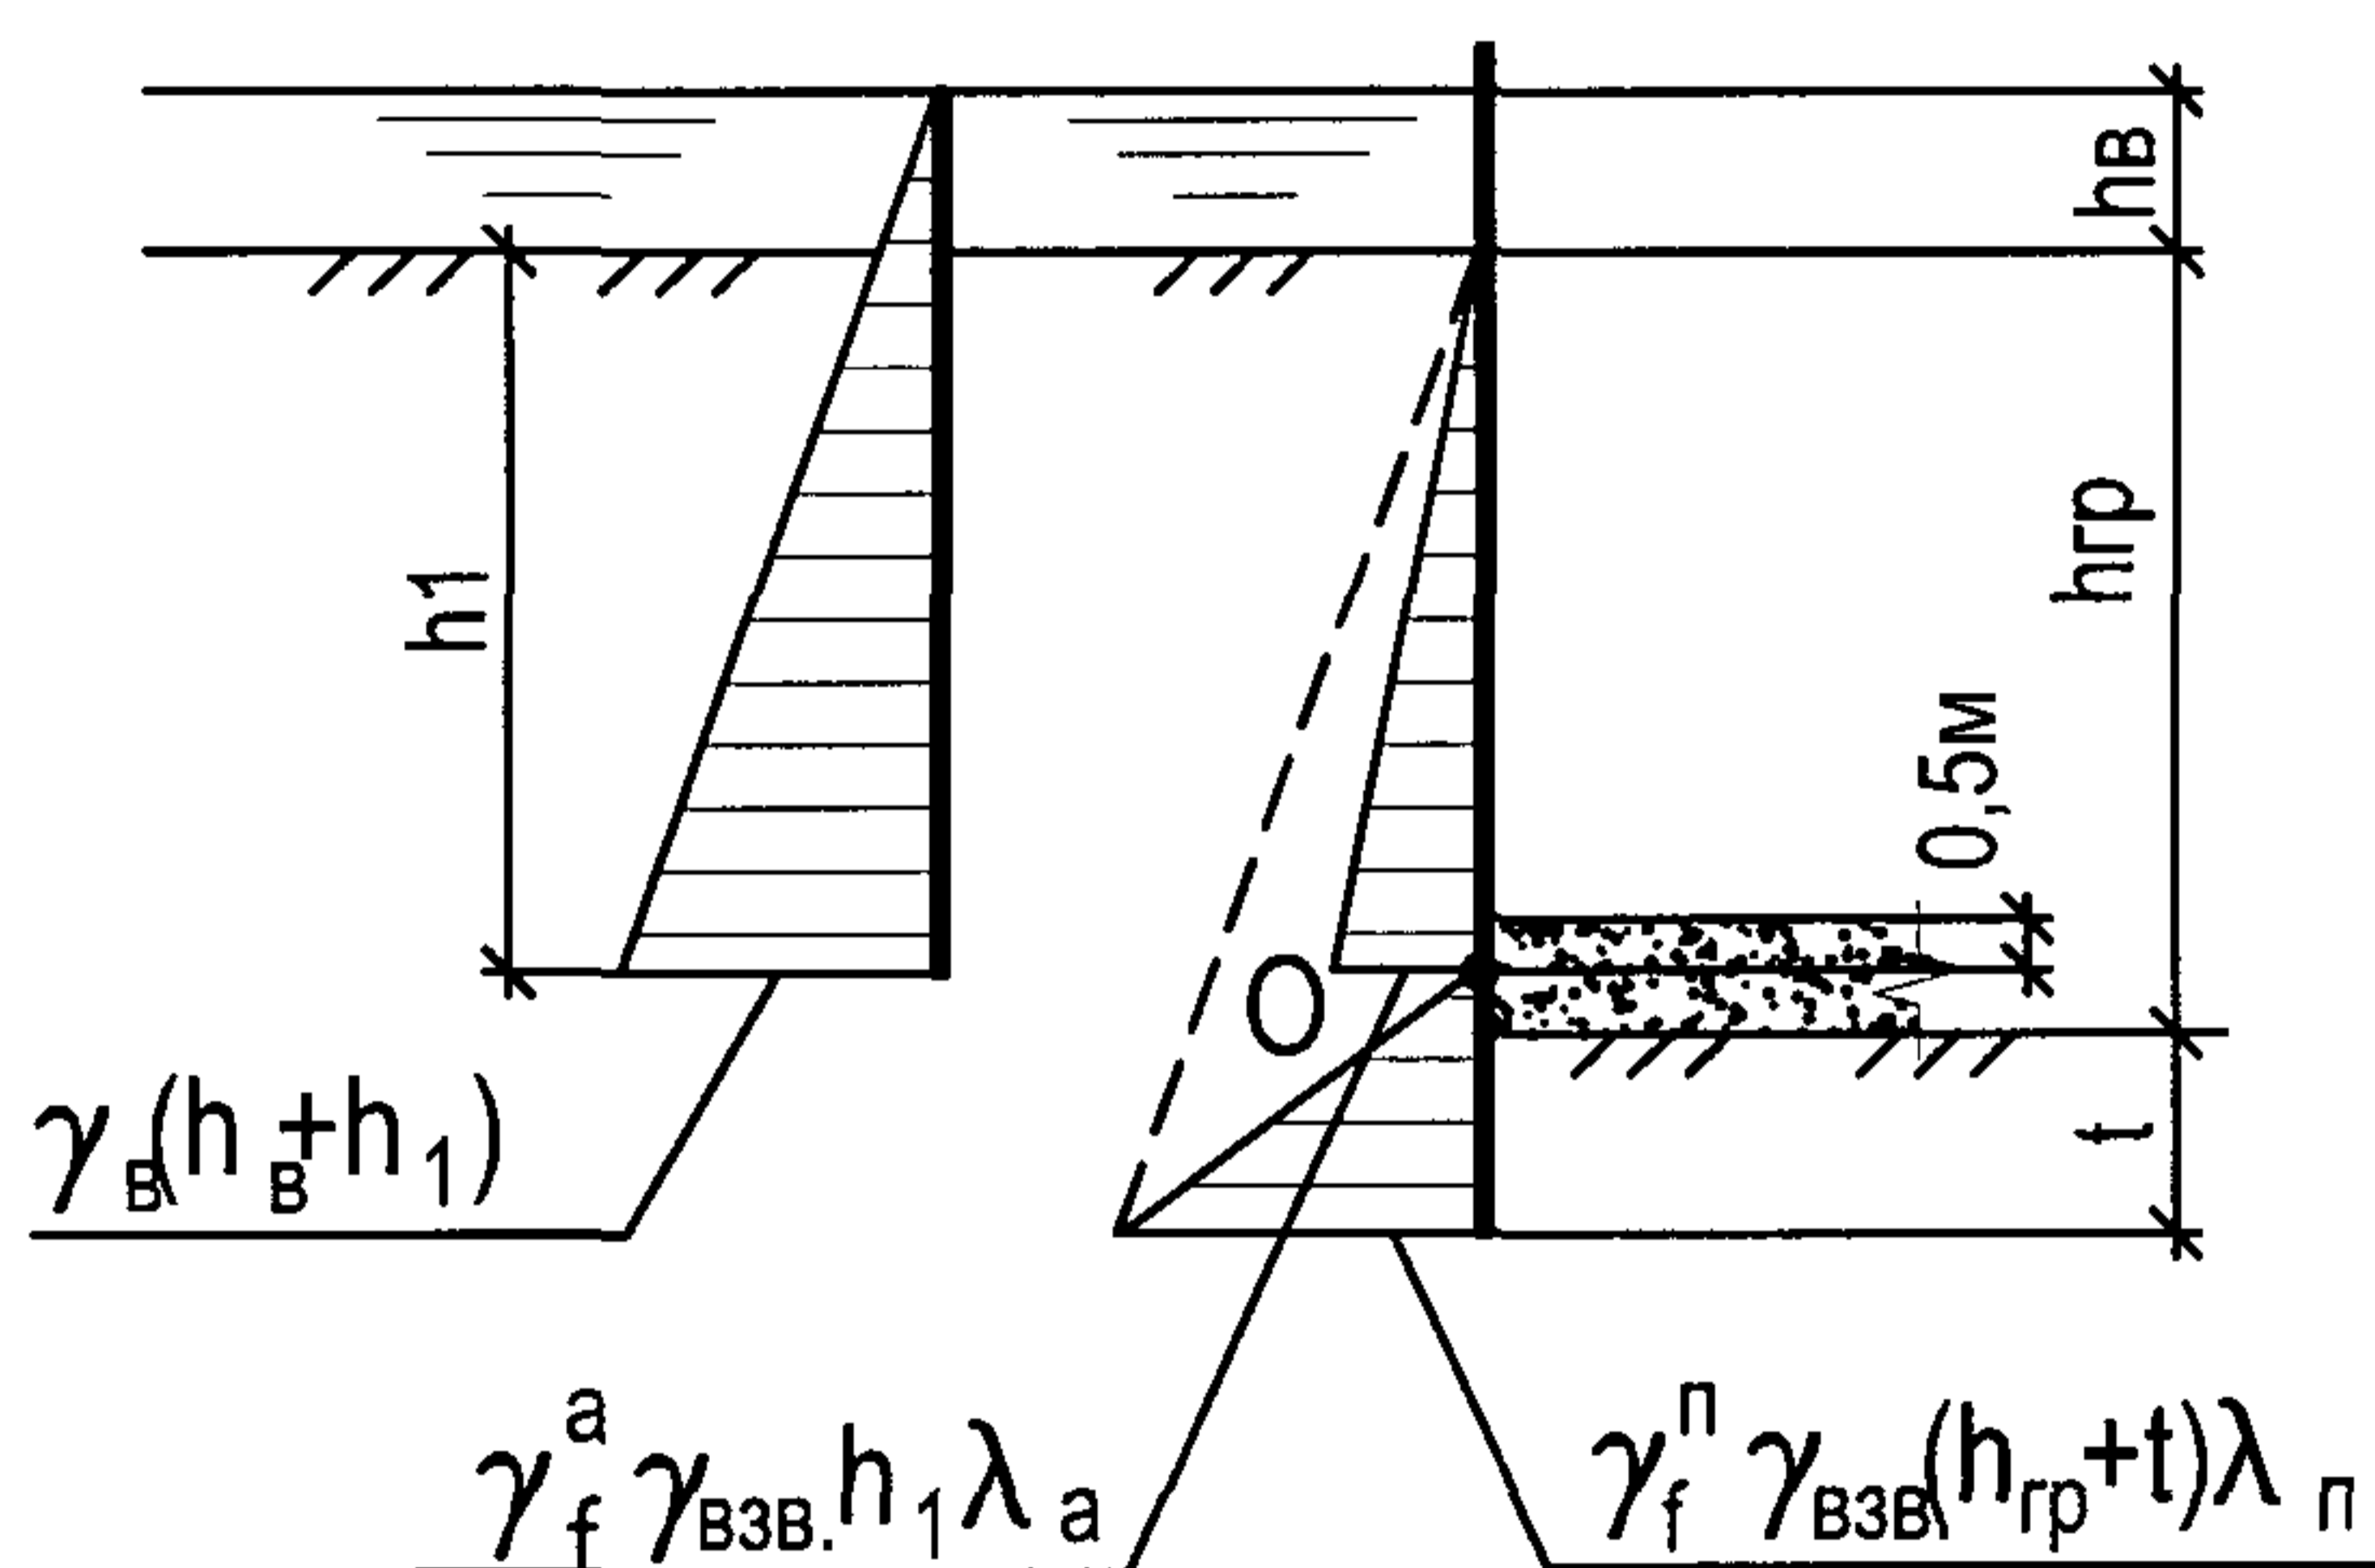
Схема, используемая в расчетах шпунтовых ограждений, не имеющих распорных креплений в водонепроницаемых грунтах с применением водозащитной подушки.
